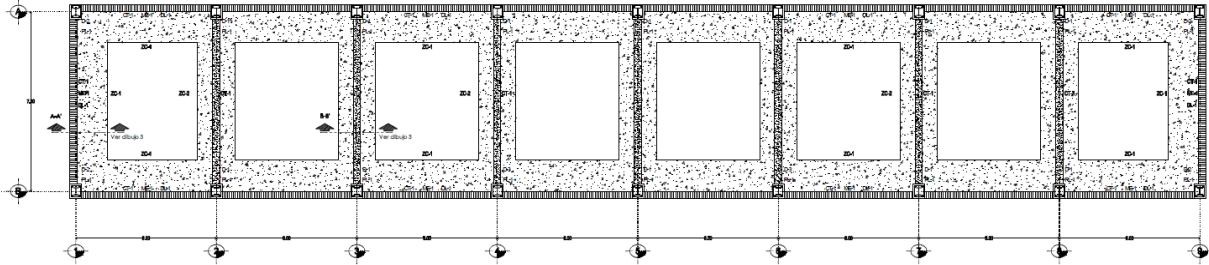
Arreglo de cimentación para edificio eléctrico
